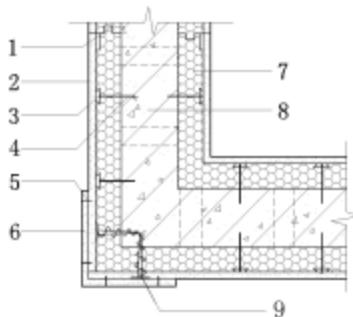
水泥板与墙体阳角连接组合构造示意（水平剖面）
